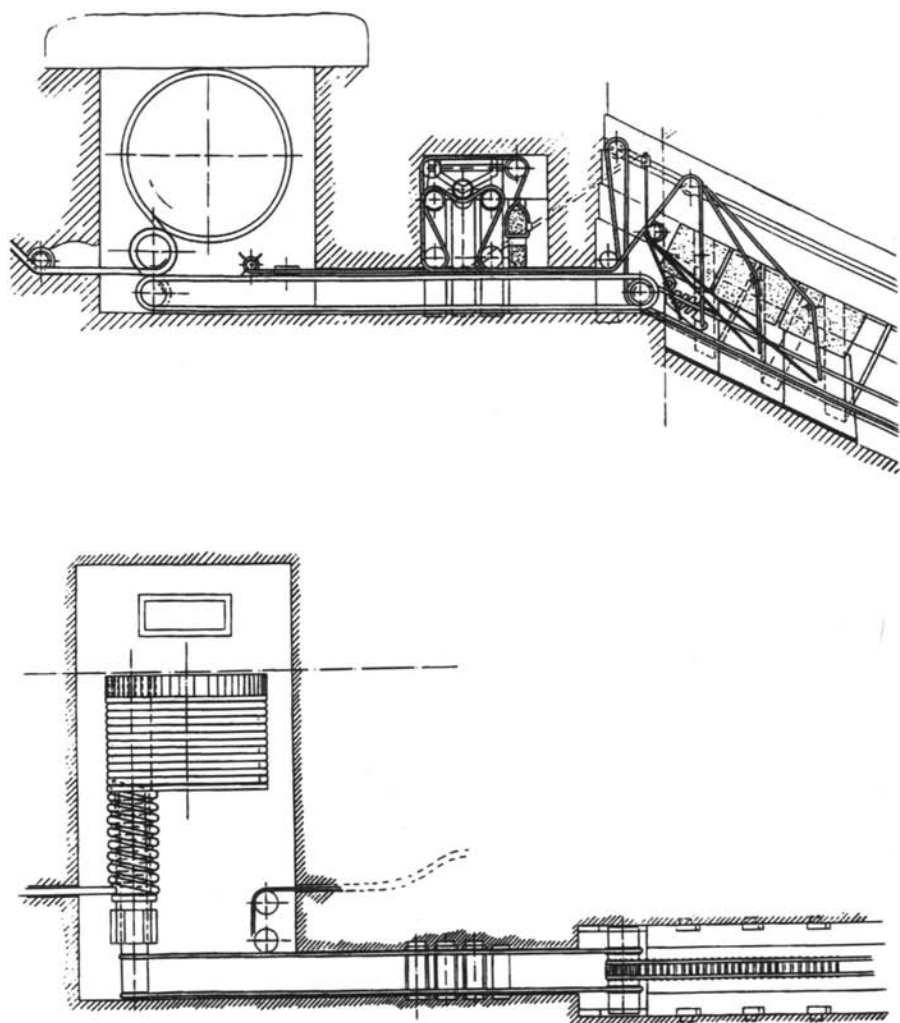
Vista en alzado y planta de la Cámara del Rey, Antecámara y Gran Escalón con trineos-contrapeso.
